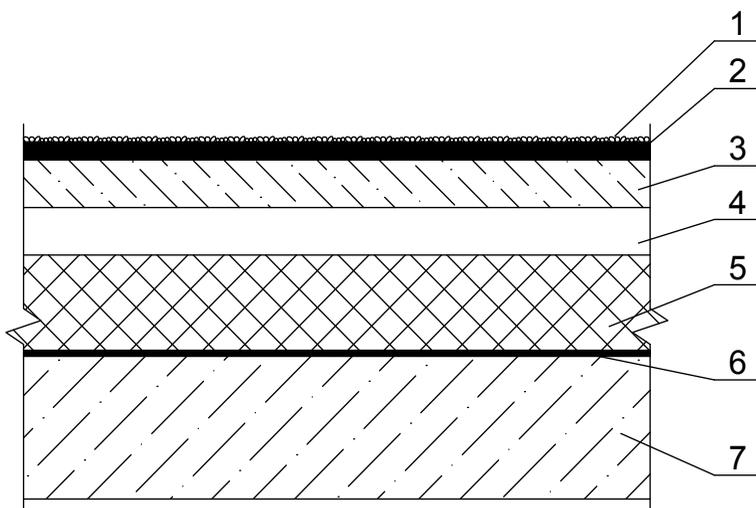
Вентилируемая (двухоблочковая) кровля:
